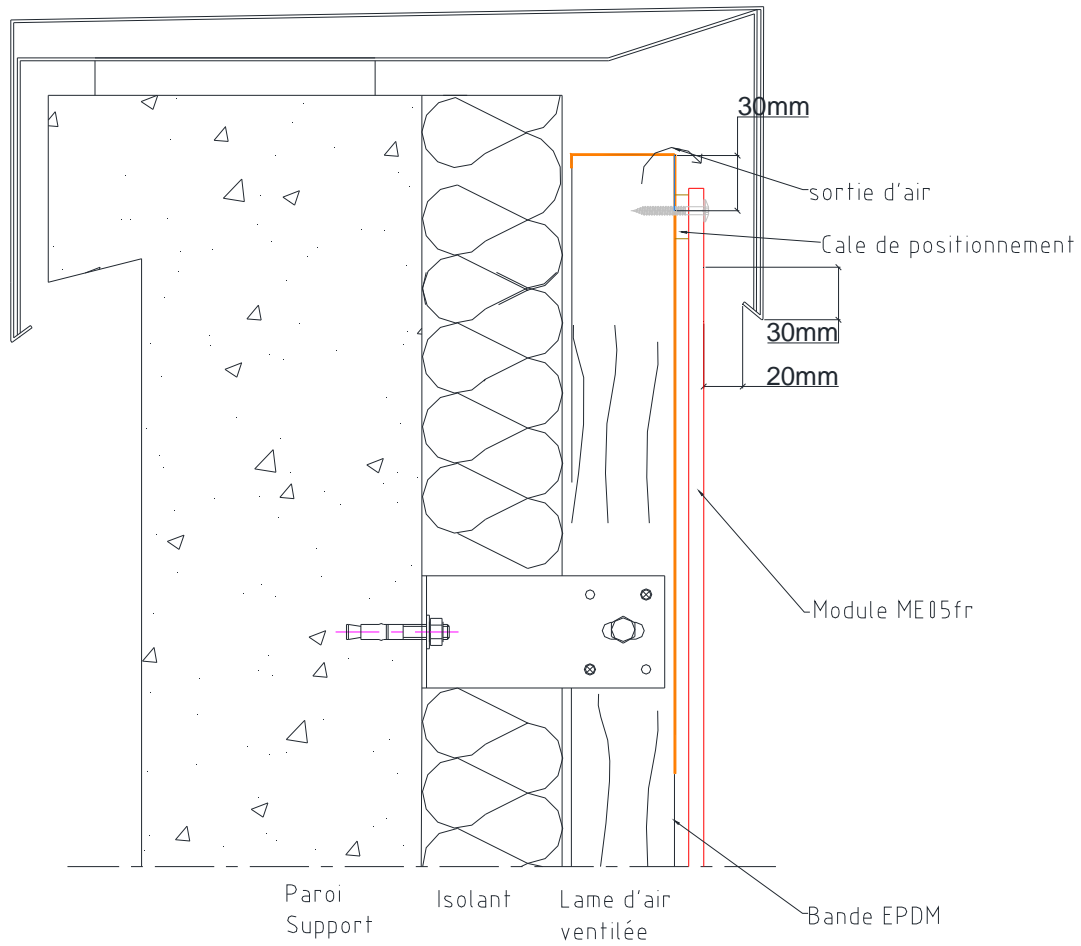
is – Arrêt sur acrotère (fixation par vis)
